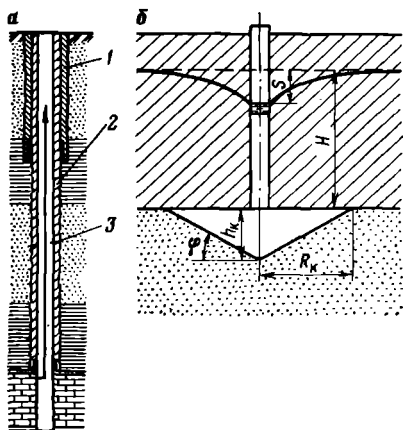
Схема конструкции бесфильтровой скважины:
